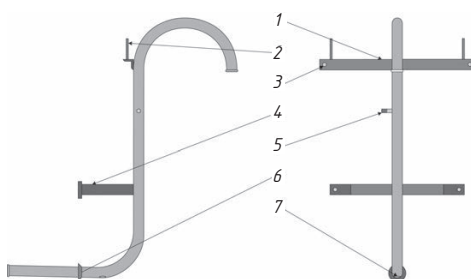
Трубостойка для крепления на стене: 1 — перекладина; 2 — штырьки для изоляторов; 3 — проушины для растяжек; 4 — кронштейн для крепления к стене; 5 — болт для заземления; 6 — ограничительное кольцо; 7 — отверстие (5 мм) для удаления конденсатной влаги
